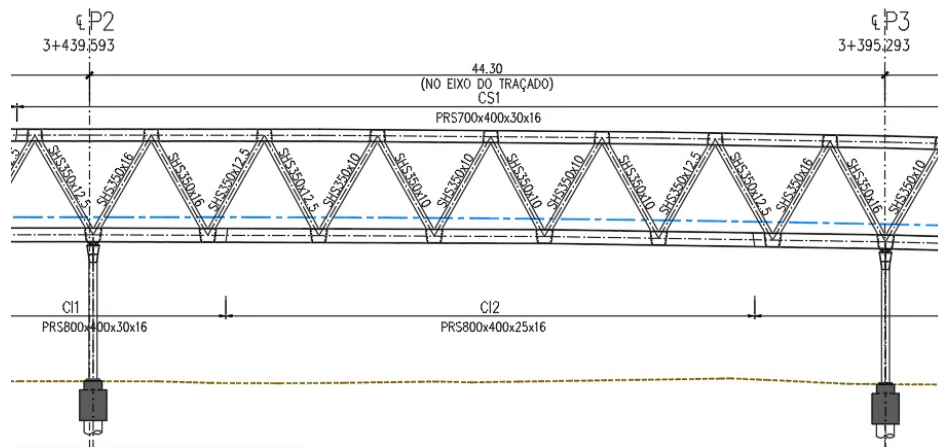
Figura Alçado parcial das vigas Principais e secções tipo das cordas.
